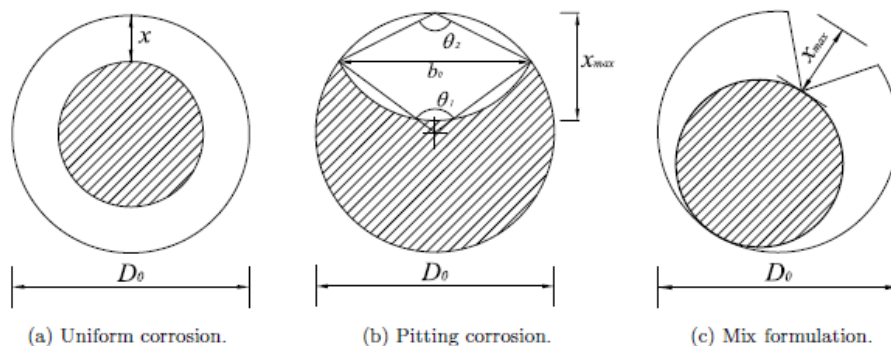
Modelli di riduzione di sezione delle armature [40]
